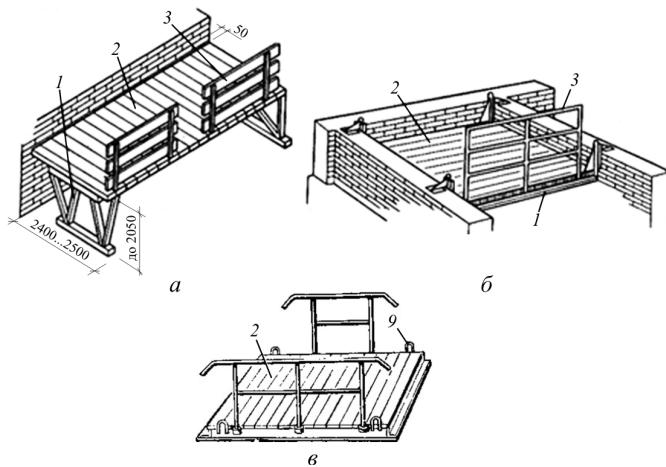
Навесная площадка: *а* – шарнирно-панельная при кладке второго яруса; *б, в* – переносные для кладки стен лестничной клетки; 1 – опора; 2 – настил; 3 – инвентарные ограждения
